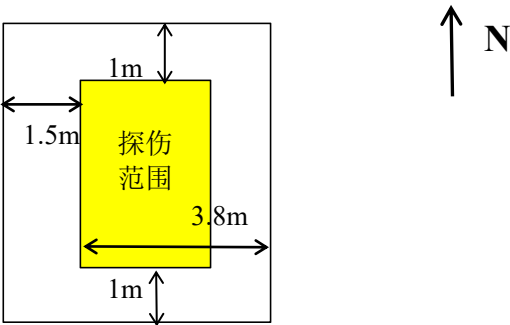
探伤机距探伤室各墙体距离示意平面图
